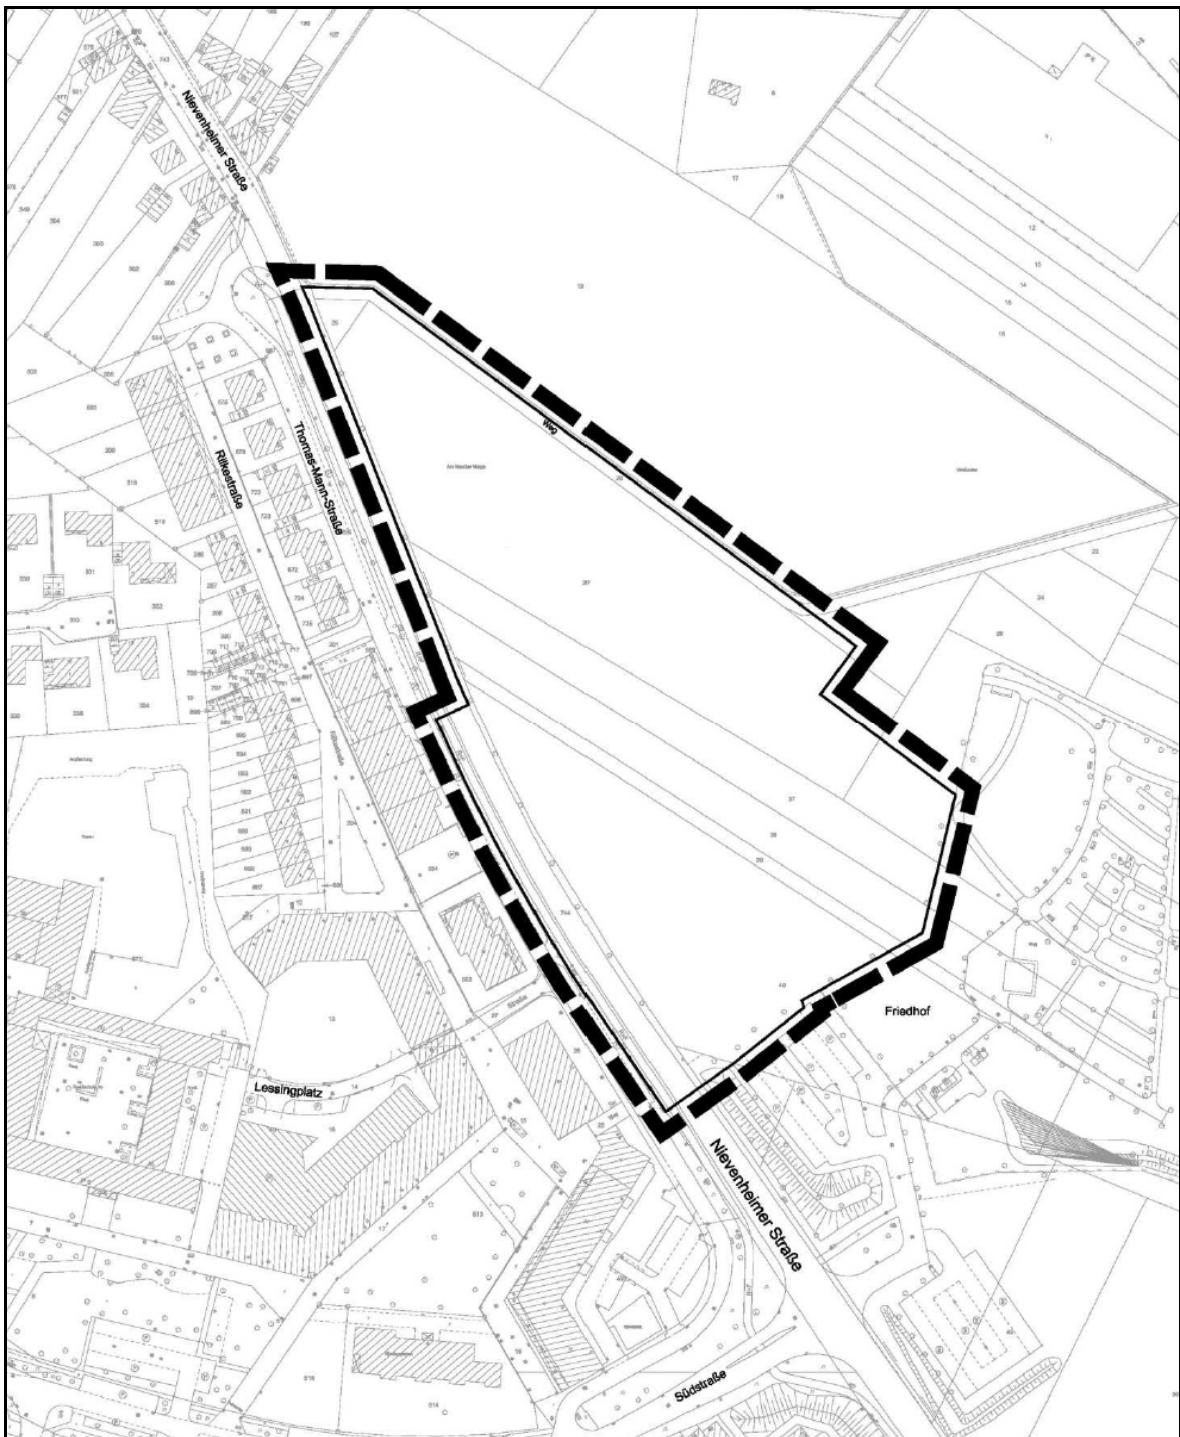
Lage des Plangebiets des Bebauungsplan Nr. 460
